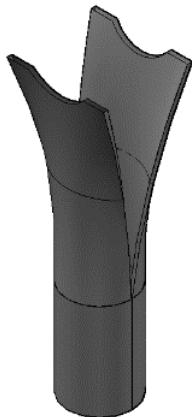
Конструкция опоры из сверхпрочного полимера
